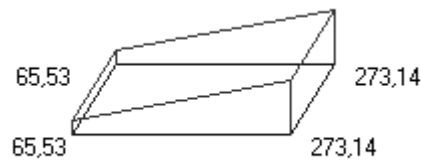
Схема до розрахунку величини навантаження на фундамент
